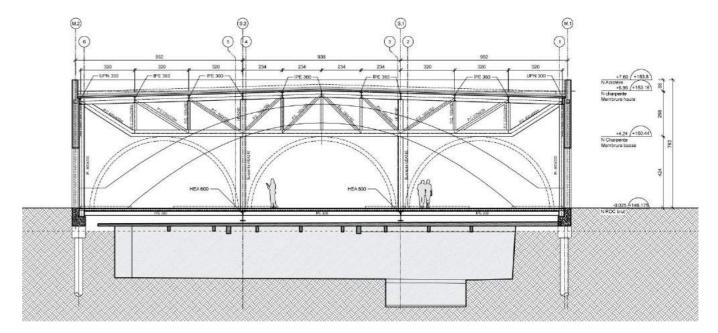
figuration des fondations du bâtiments au regard des caves (coupe transversale). Studiolada
